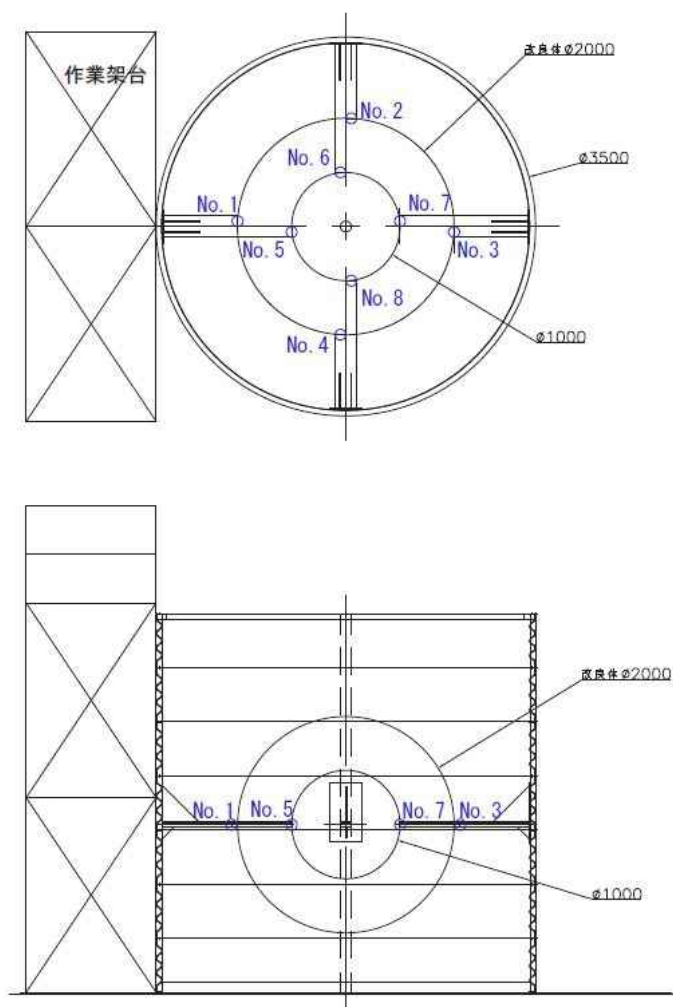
間隙水圧計配置図 (上：平面図, 下：断面図)
